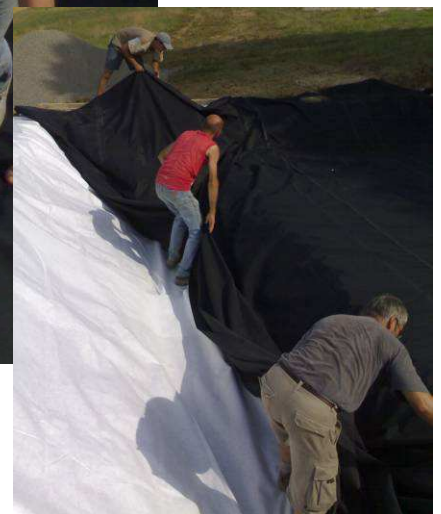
mise en place de la bâche étanche en EPDM (4)
